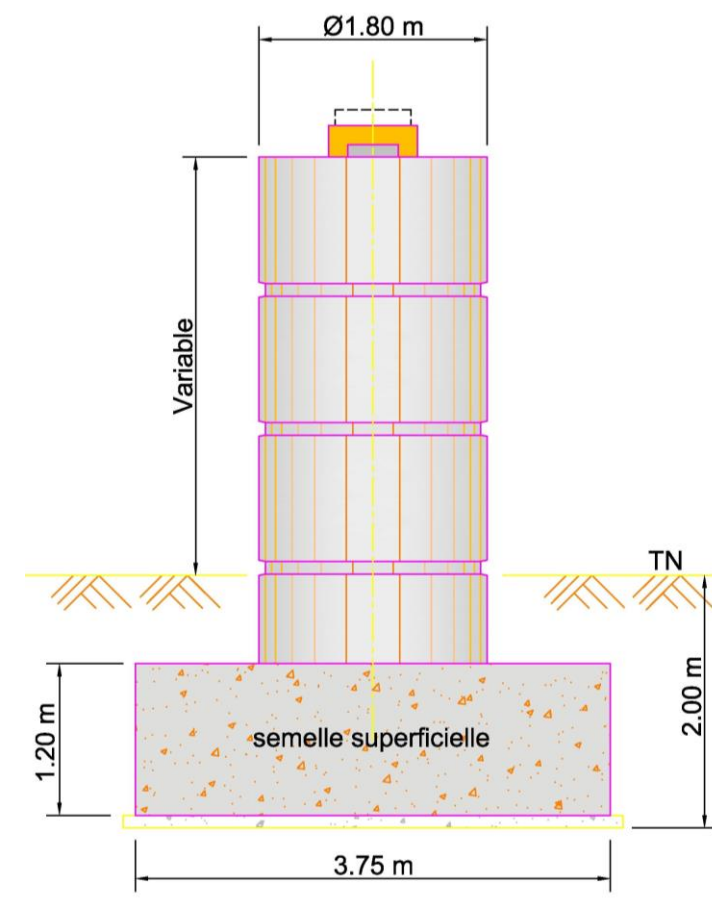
Schéma de principe des fondations des piles du viaduc (PI9)
